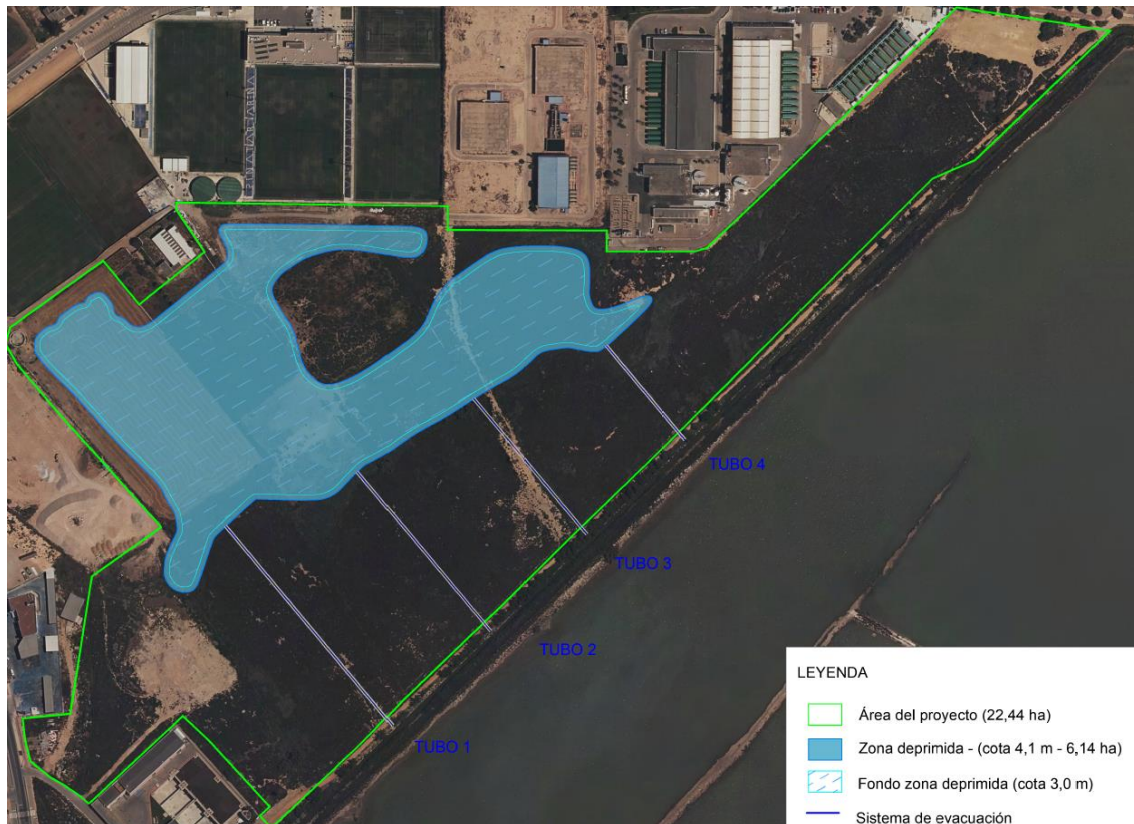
Planta de las tuberías de desagüe de la zona inundable.
